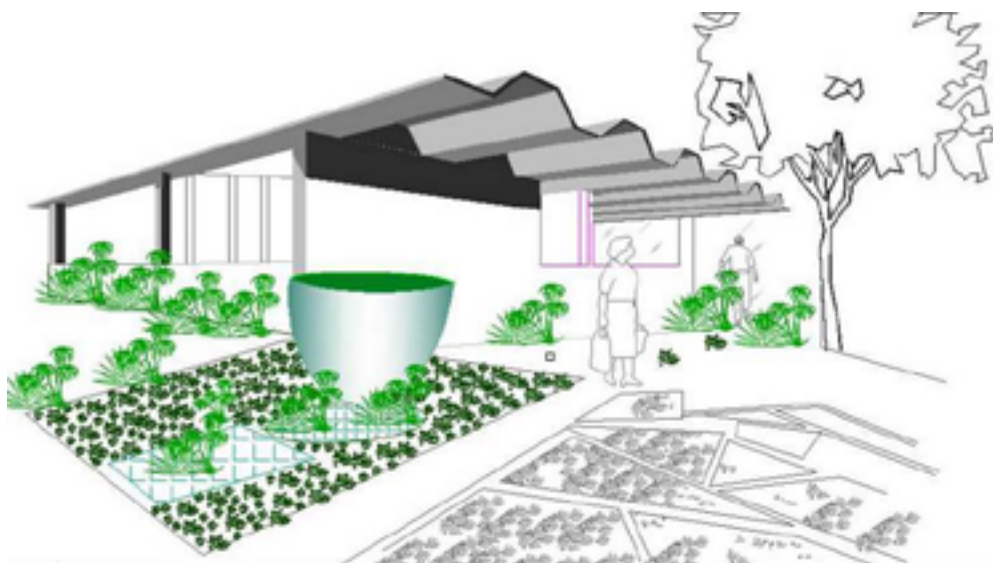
Cubierta prismática vista desde la fachada posterior de la Casa de Novedades No 2
